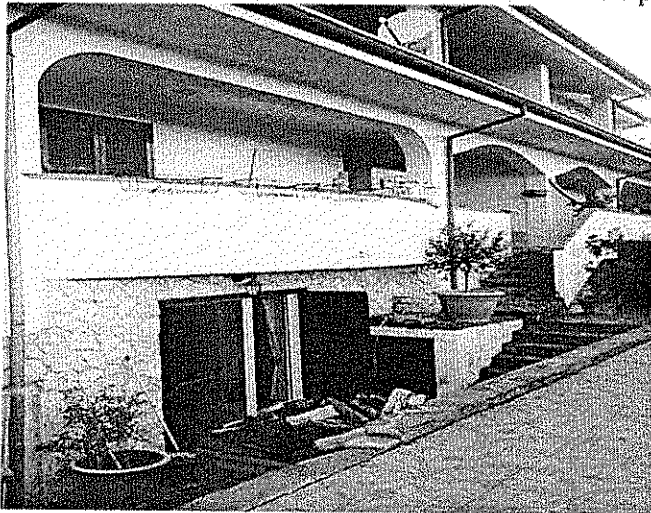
e 10 -Particolare facciata posteriore e del P.S.1° -Particolare laterale della Corte/Giardino.
